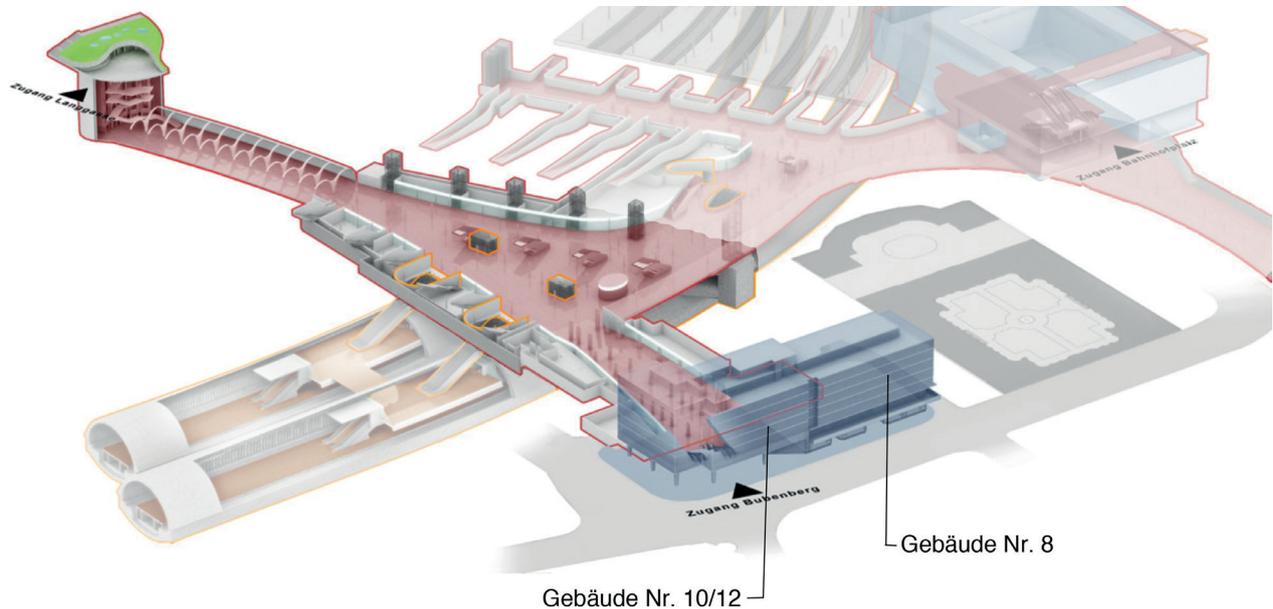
, Geplante Unterführung Mitte mit Bezug zu den Gebäuden Bubenbergplatz 10/12
